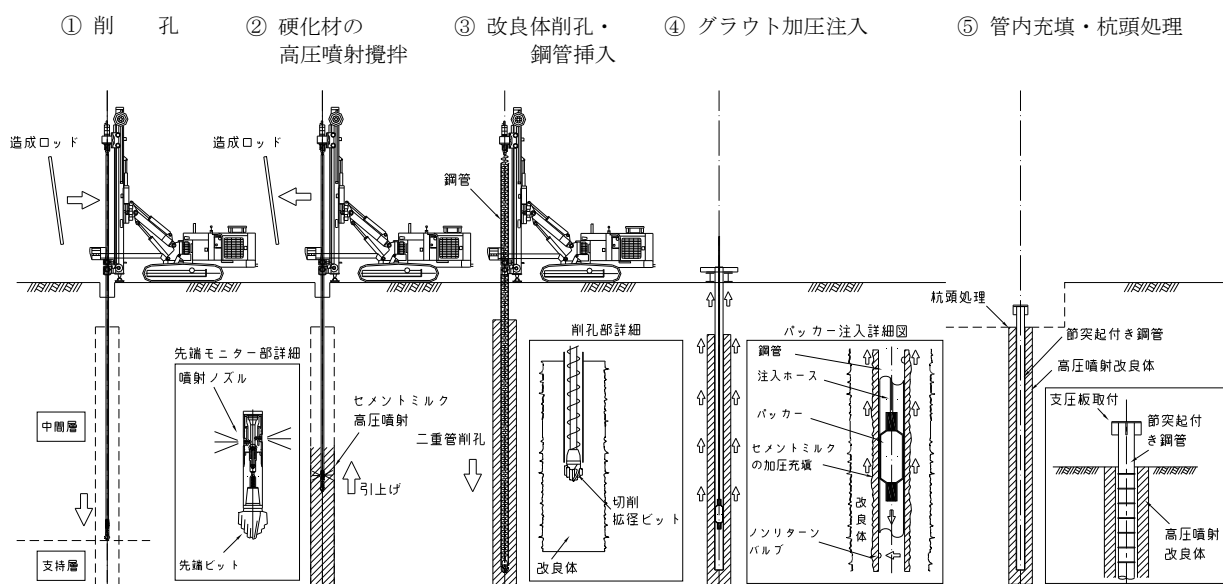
STMP タイプⅡの標準的な施工手順
